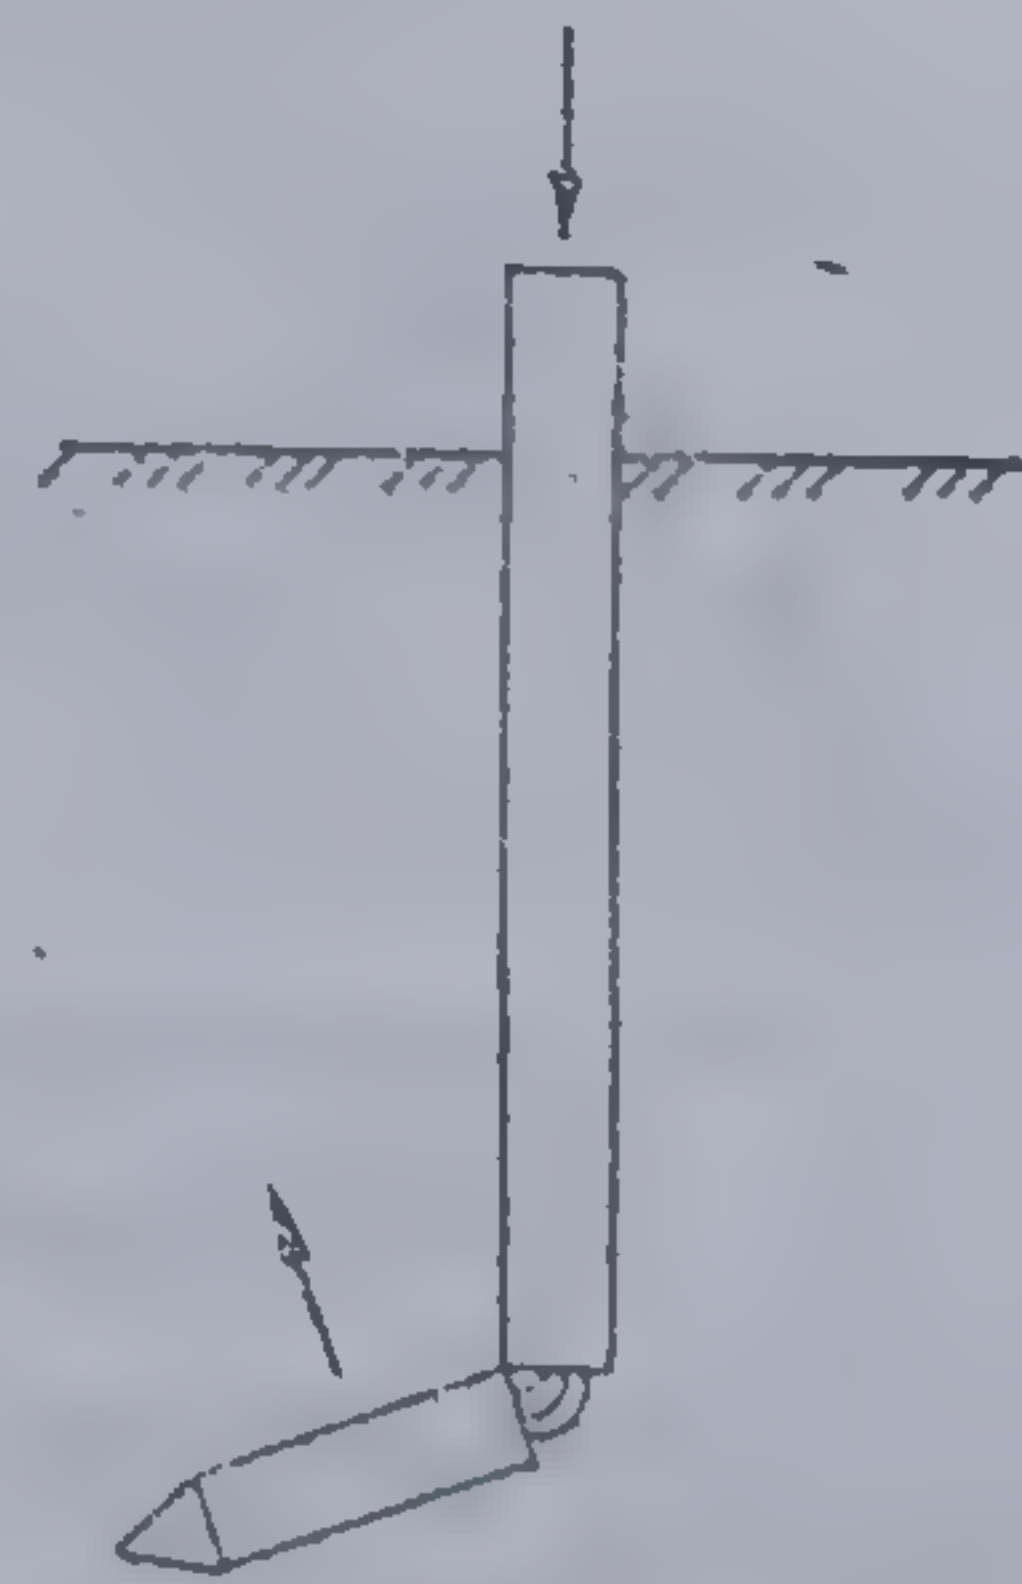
Pilot din beton armat rupt în timpul baterii.
